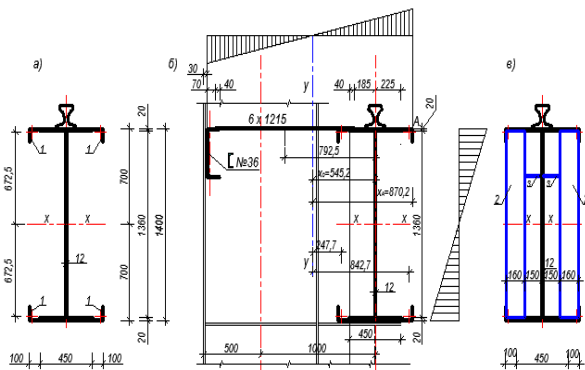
Сечение подкрановой балки: а) усиление по способу II; б) к расчету подкрановой балки; в) наращивание поперечных и установка продольных ребер жесткости: 1 – $\angle 100 \times 8$; 2 – $\angle 160 \times 10$; 3 – $\angle 150 \times 10$.
